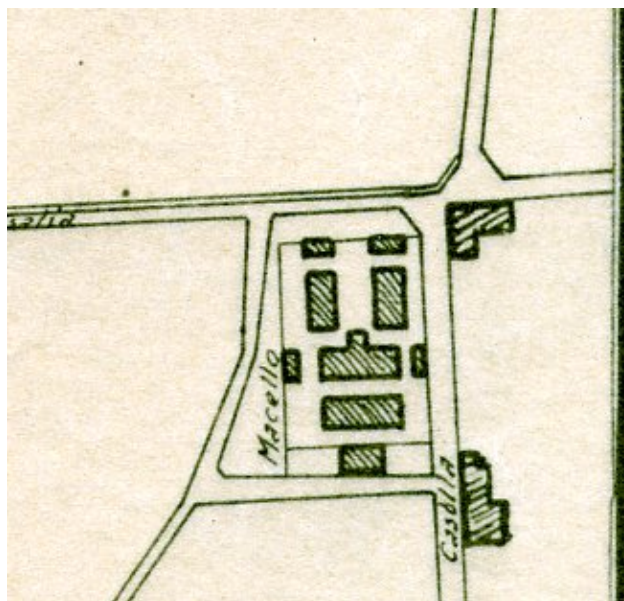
Pianta del macello nuovo, dalla planimetria di Francesco Paparo, 1937 (ASCCE)²⁴⁰.
